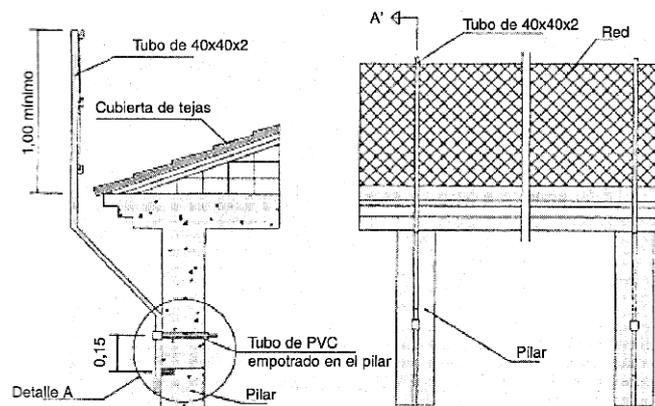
Barandilla perimetral. Protección colectiva de los bordes de cubiertas y tejados.
